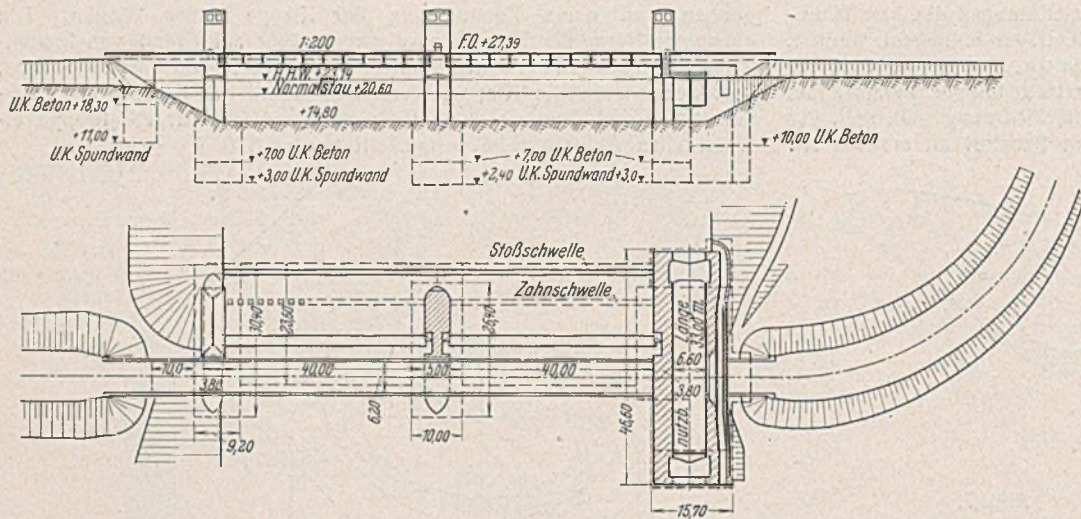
Wehranlage mit 2 Öffnungen von je 40 m Lichtweite im Grundriß und Ansicht.
